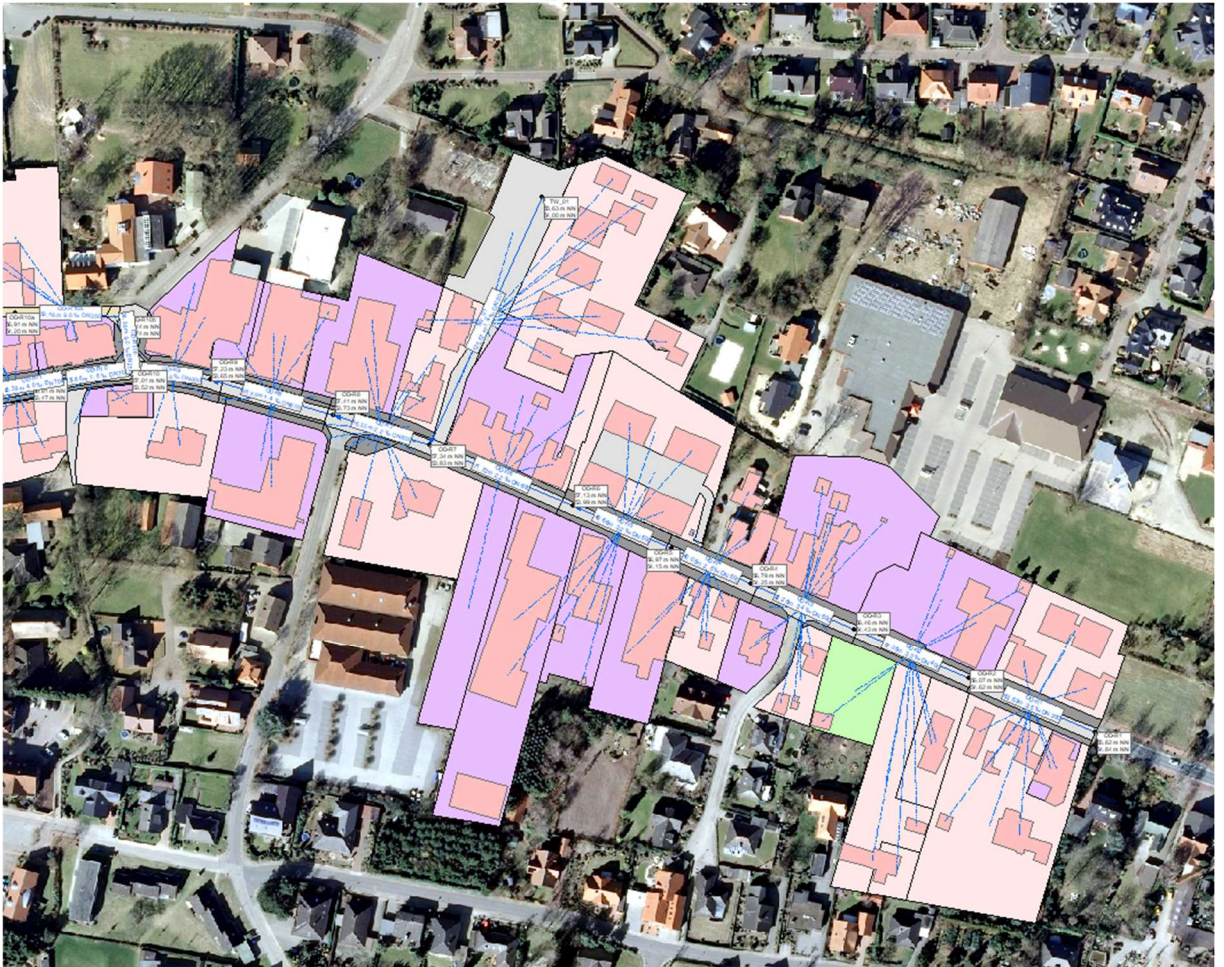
Lageplan Modell Bestandsnetz "Ortsdurchfahrt Emstek"
